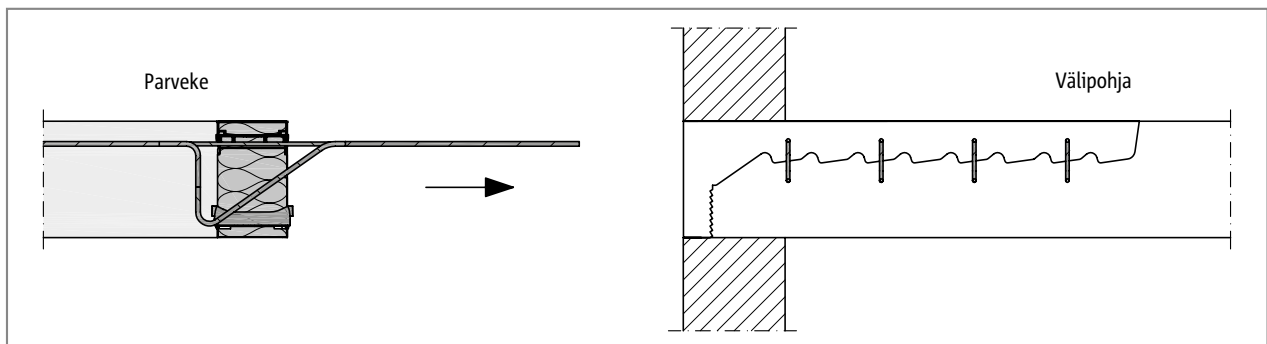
Schöck IDock®: Pilareilla tuettu parveke; eristeosana Isokorb® QXT-E, QPXT-E
